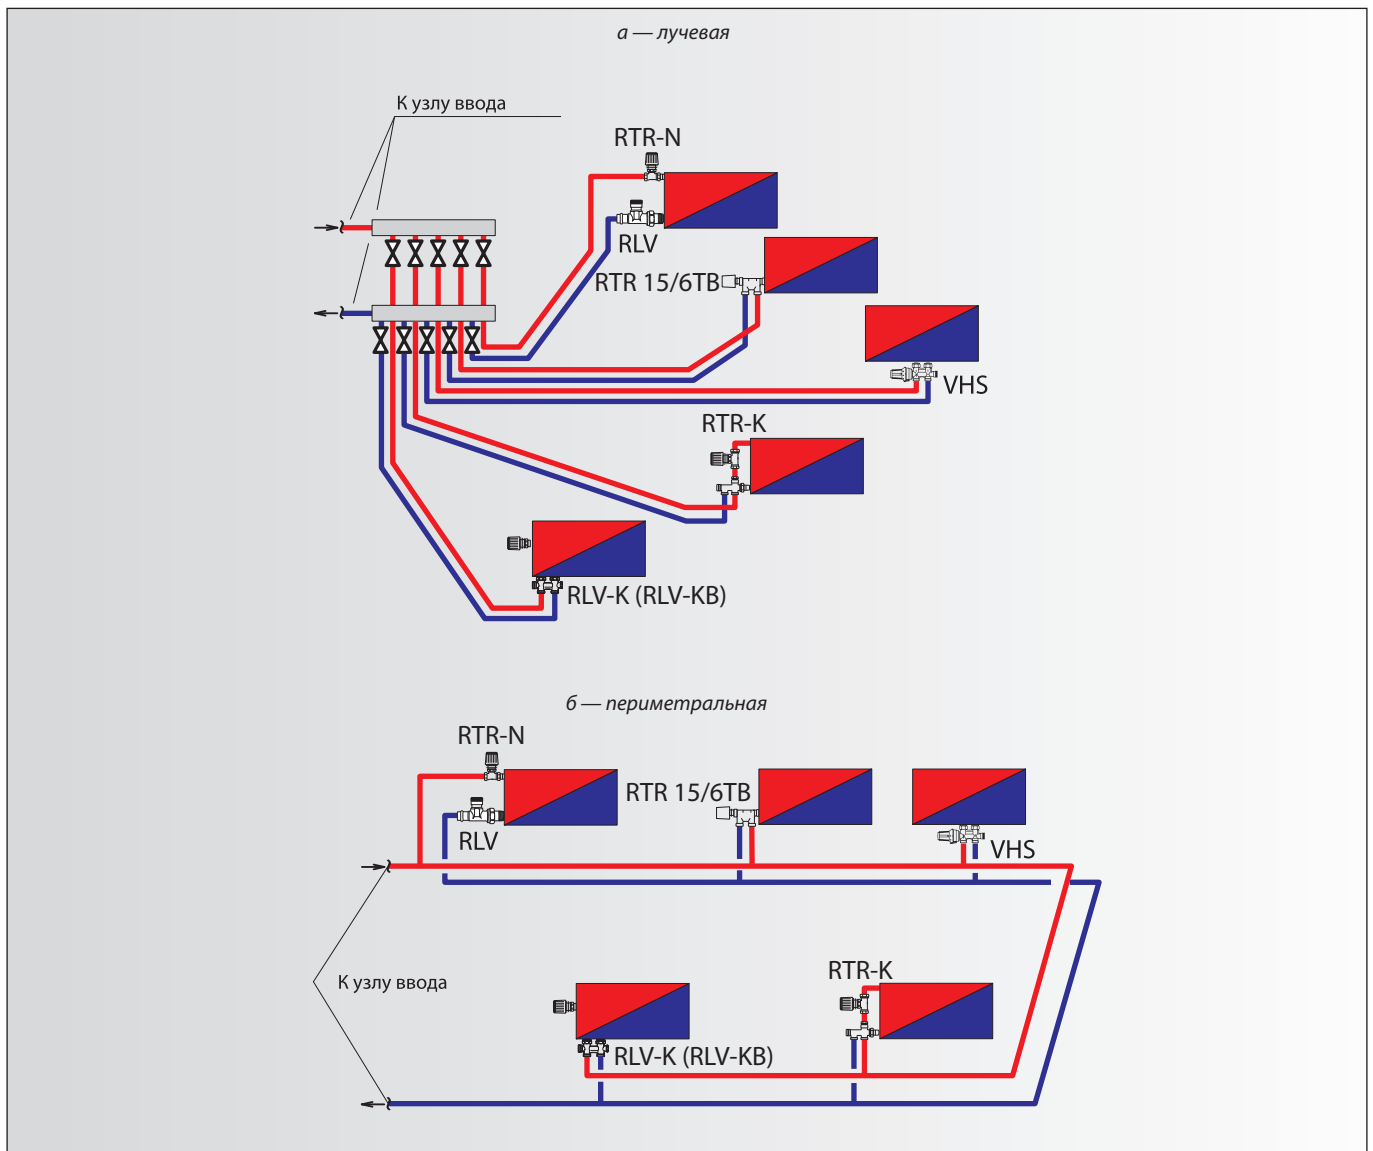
Двухтрубная разводка квартирных трубопроводов.
